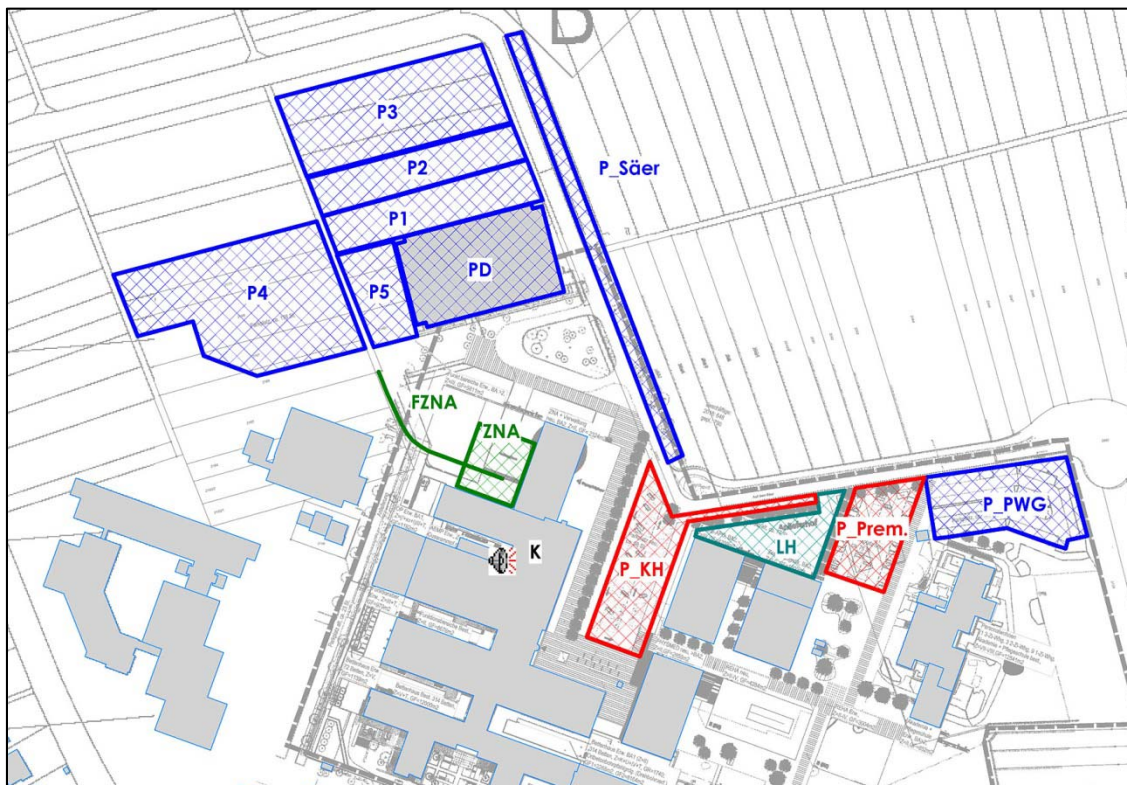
Lageplan mit Darstellung der relevanten Schallquellen
